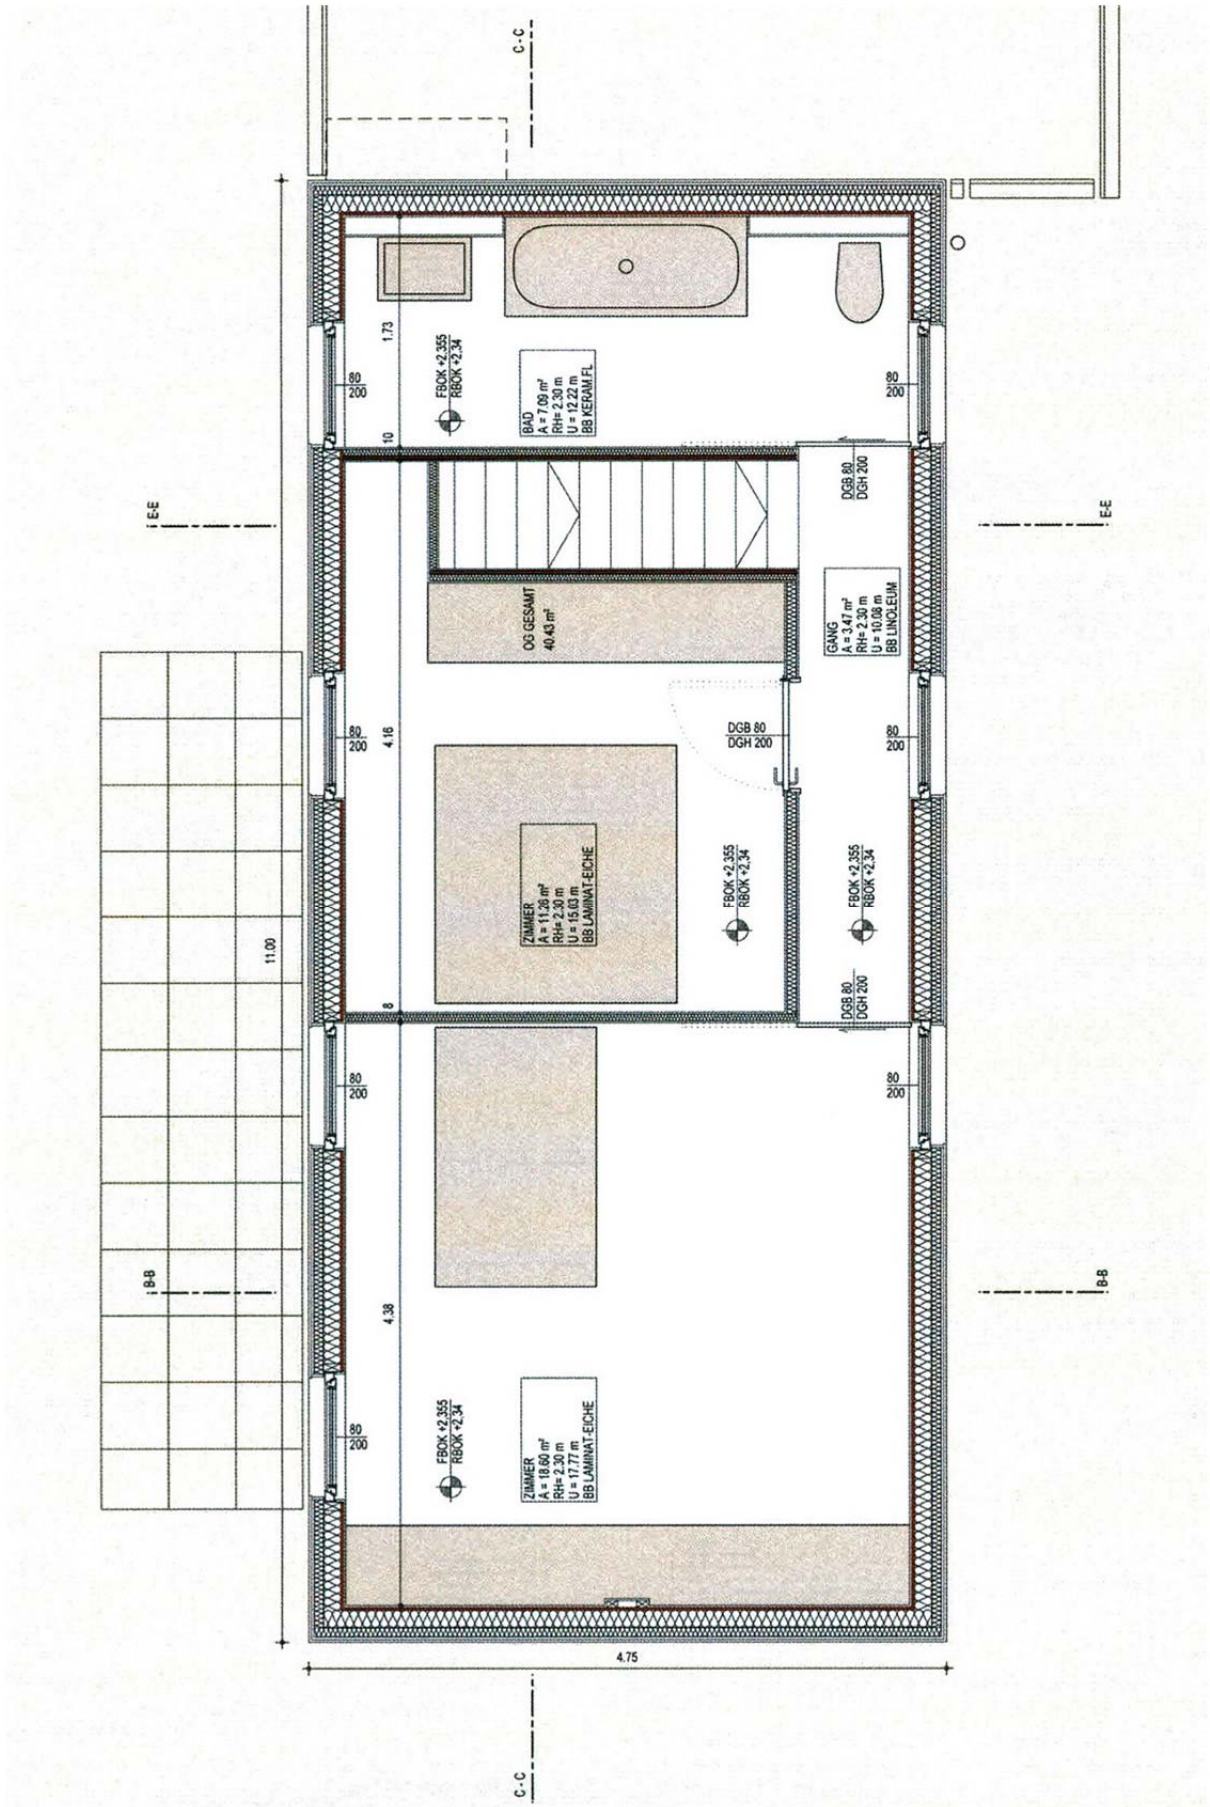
Grundriss Obergeschoss _ Typ D mit Keller
